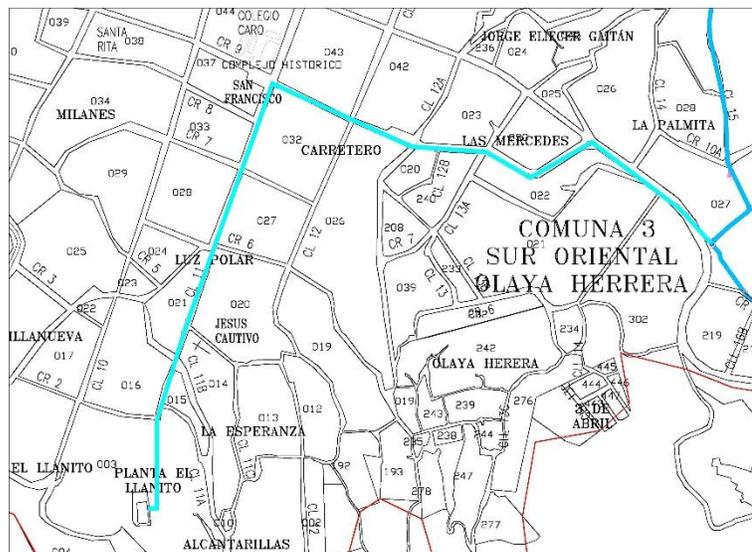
Localización en planta de la tubería de conducción bifurcación denominado San Cayetano- tanque El Llanito. Fuente: Pasante del proyecto.
